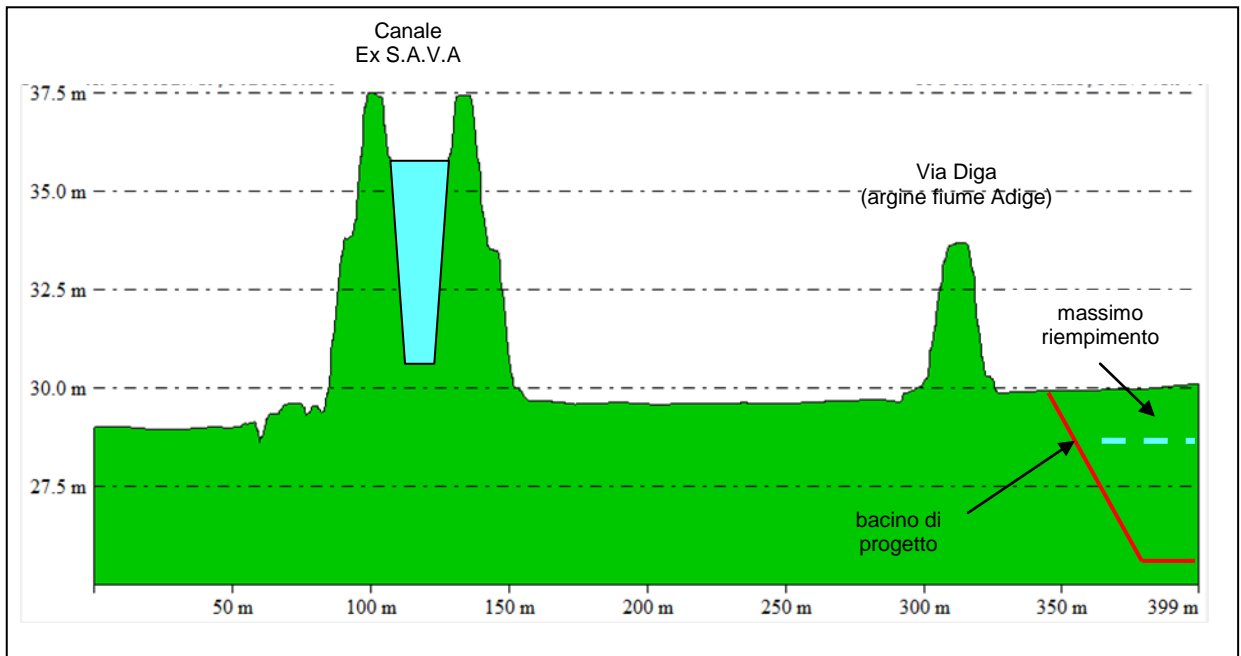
Sezione trasversale 1049 fiume Adige.
